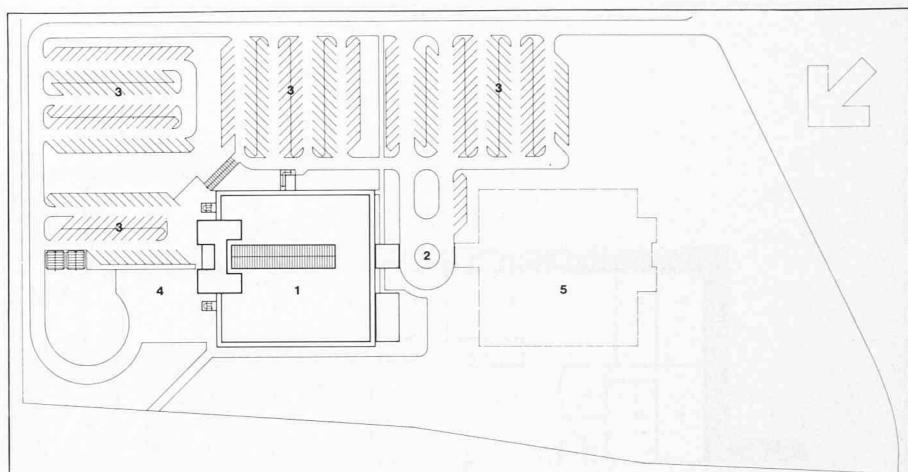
Grundriss. 1 Hauptgebäude, 2 Eingang, 3 Parkplatz (387 Plätze), 4 Dienste, 5 Platz für Erweiterung
